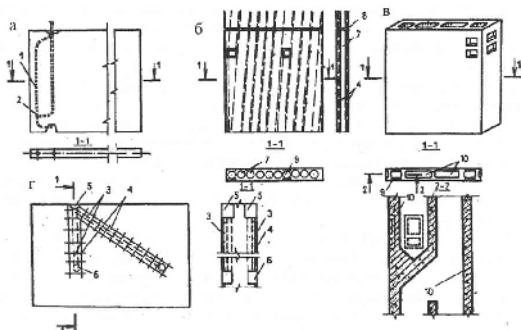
Вертикальные внутренние конструкции, включающих элементы инженерного оборудования и сетей: а – стенная панель – отопительный прибор; б – самонесущая стена из вентиляционных блоков; в – несущий вентиляционный блок; г – панель стены с каналами скрытой электропроводки; 1 – нагревательный элемент; 2 – регулировочный кран; 3 – канал для электропроводки; 4 – арматурная сетка; 5 – лунка для распаячной коробки; 6 – ниша для индукционной розетки; 7 – вентиляционный канал; 8 – цементный раствор; 9 – риска для вентиляционного отверстия; 10 – сборный канал
